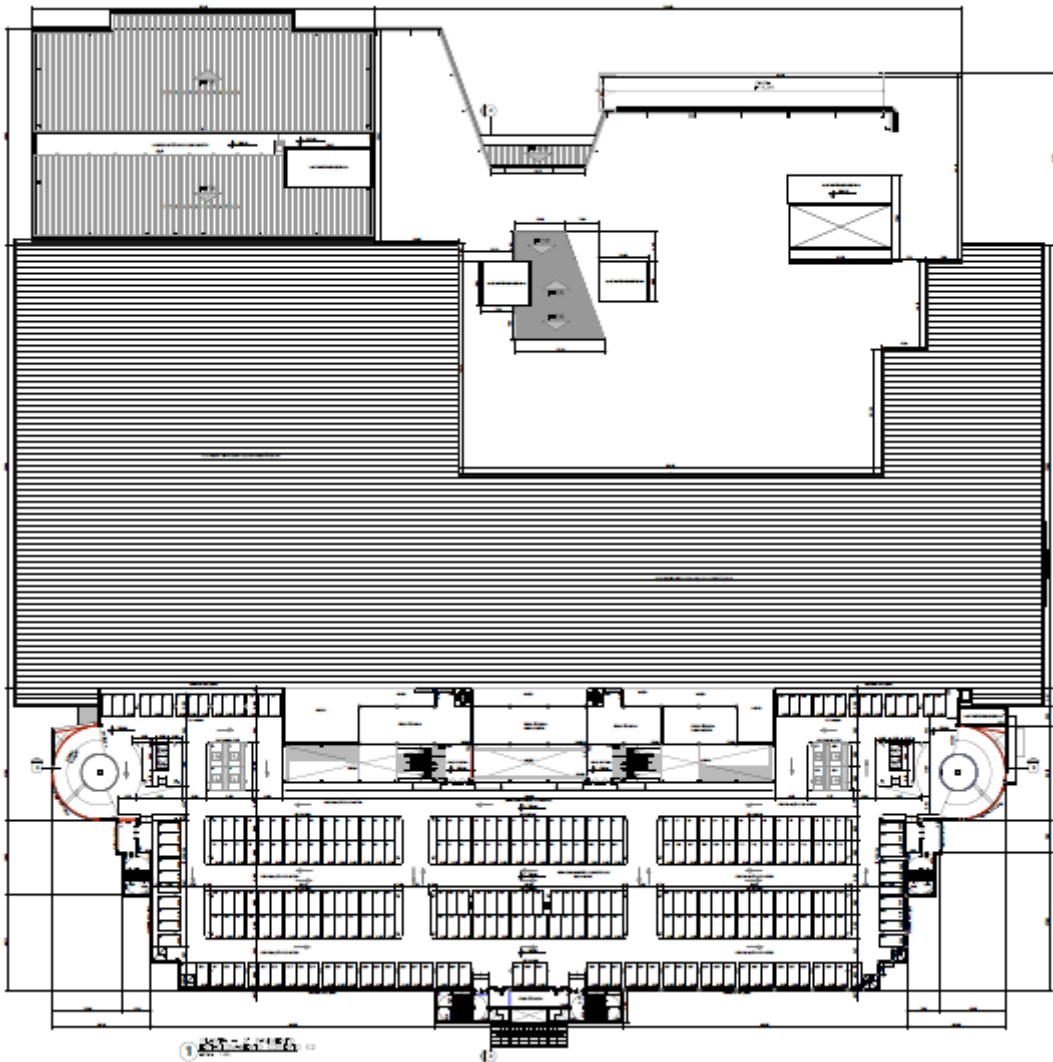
Planta Terceiro Pavimento – Estacionamento coberto G2. Fonte: Engexpor.
